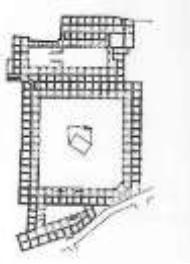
12 Balkapanı Han Plan Şeması [81].
